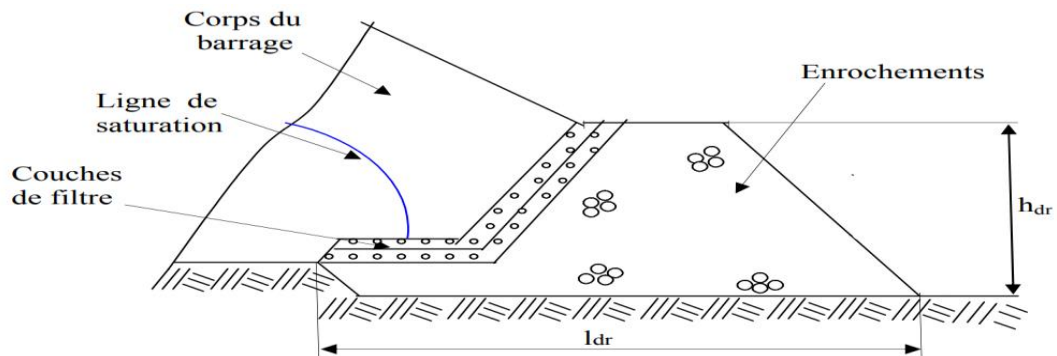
Prisme de drainage avec drain tapis interne sur fondations imperméables
